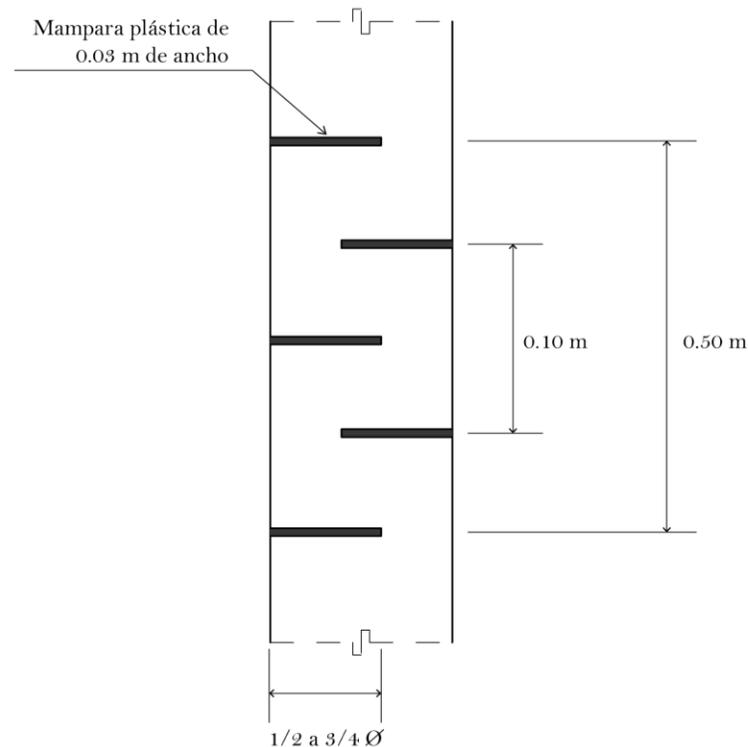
Diagrama de detalle de trampa de condensado con mamparas plásticas en sistema zigzag para tubería vertical
